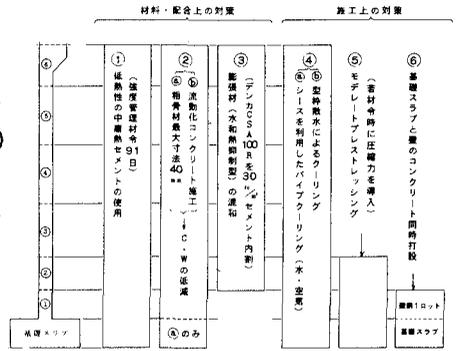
コンクリートの収縮ひびわれ制御対策
